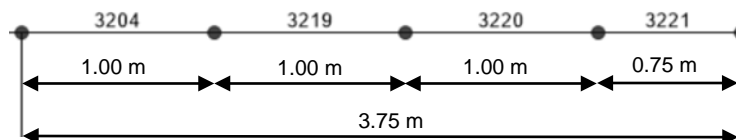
Identificação da Viga V6.6 da Travessa do Pórtico 5
